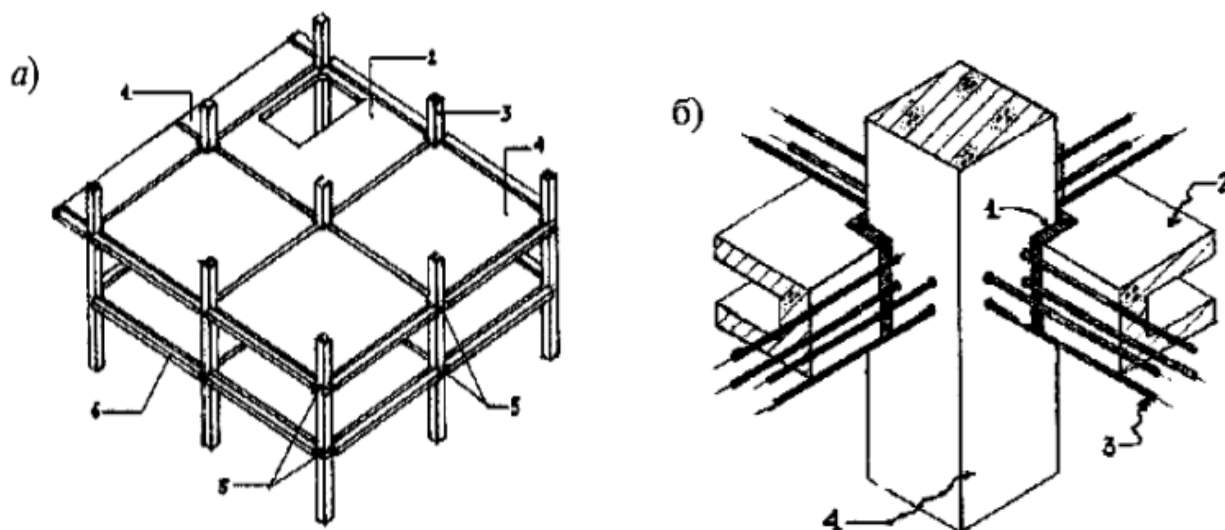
Каркас ІМС, з натягом робочої арматури в будівельних умовах для багатоповерхових цивільних будівель: а — принципова конструкція каркасу; 1 - консольне перекриття; 2 - перекриття з отвором для сходів; 3 – колона; 4 – типове перекриття; 5 - канатна арматура, що напружується; 6 - фасадна розпірка; б - конструкція вузла примикання плит перекриття до колони; 1 - контактний шов; 2 - плита; 3 - канат К-7; 4 – колона
